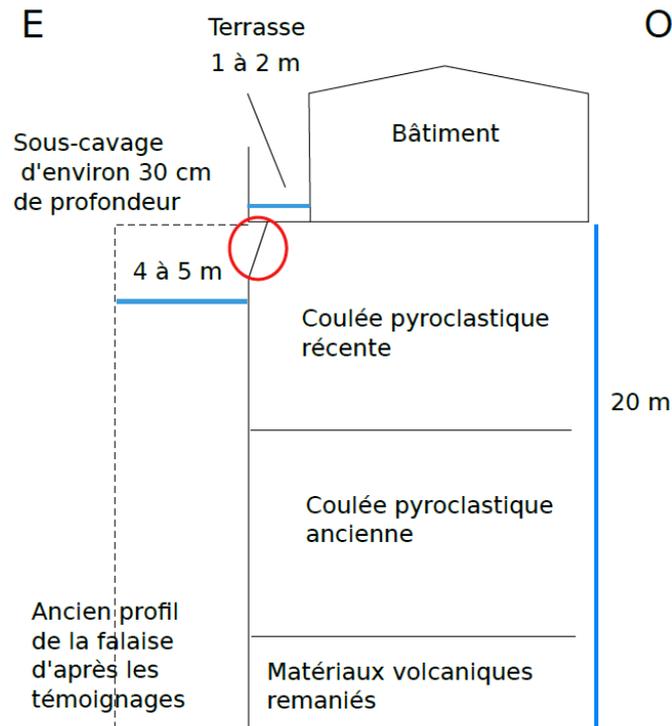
Coupe schématique de la falaise côtière au droit du bâtiment de la parcelle AH 56
